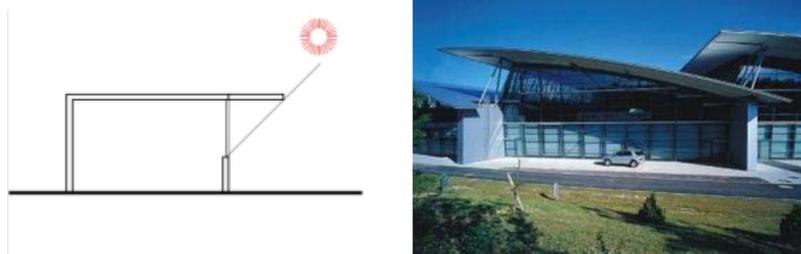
Esquema de Voladizo y ejemplificación - Mercedes Benz, Stuttgart –Renzo Piano
